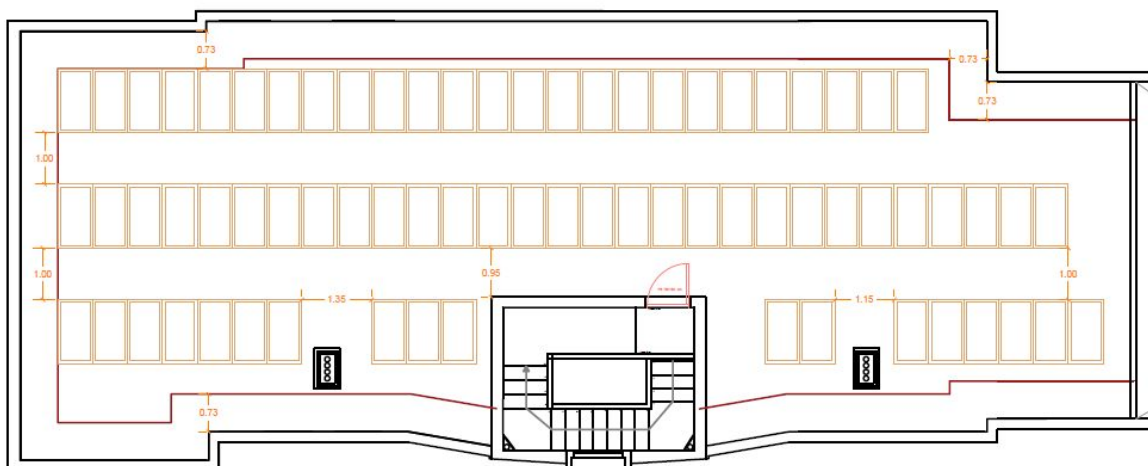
Planta cubierta E5 con 72 placas instaladas (Fuente: Anejo A)
